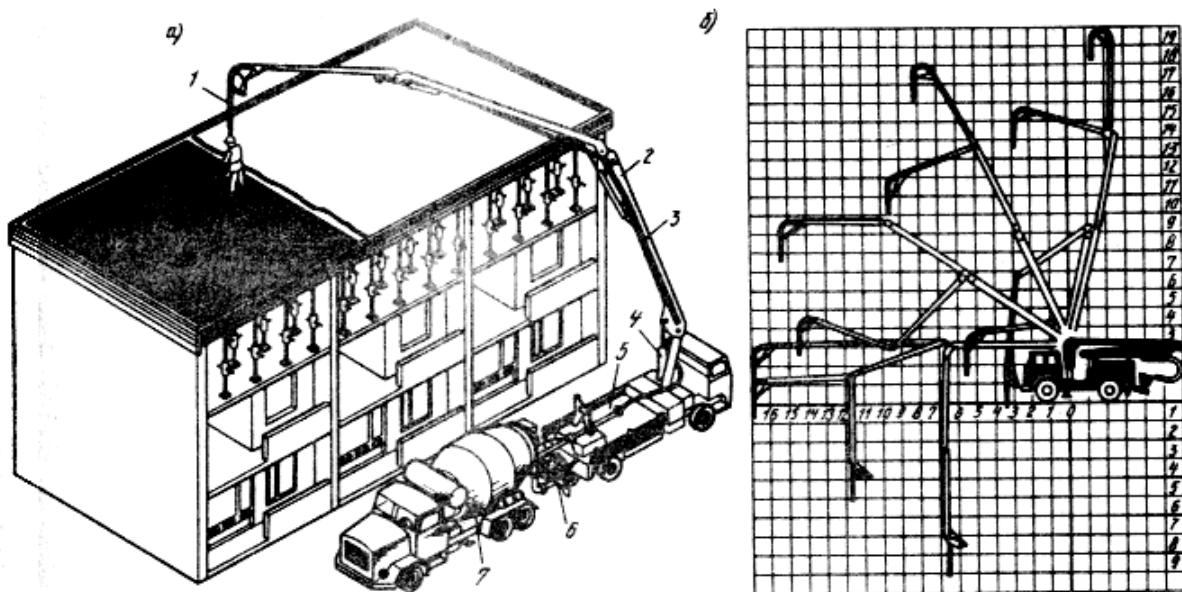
Подання бетонної суміші автобетононасосом:
